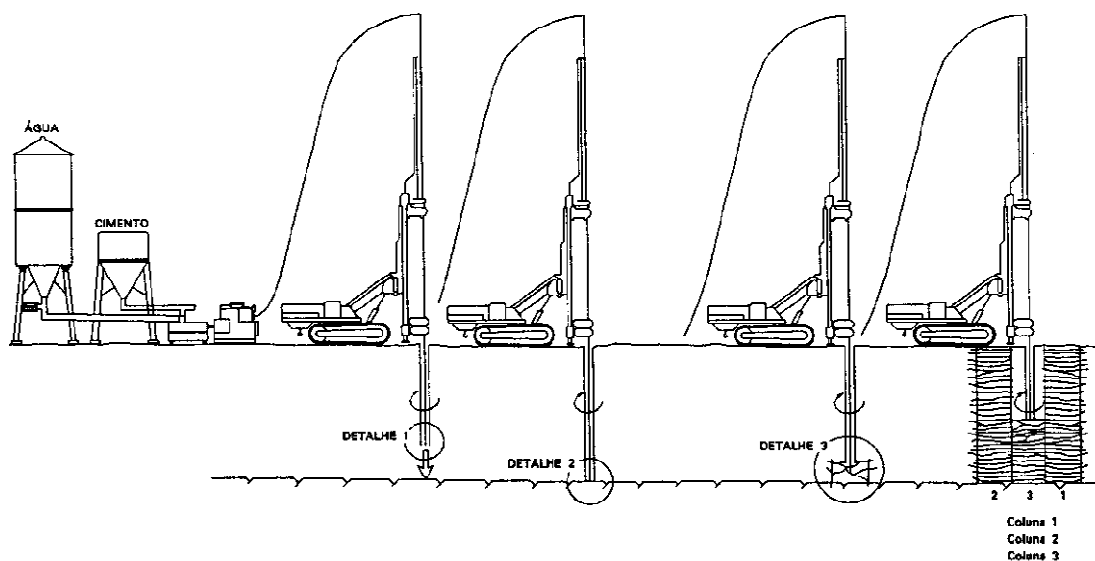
Jet grouting: Processo construtivo (Carreto, 2000).
